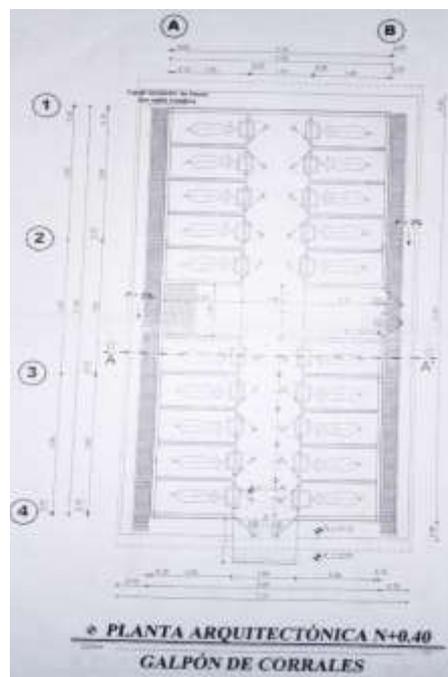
4.3. Planta Arquitectónica N+0.40. Galpón de corrales.
